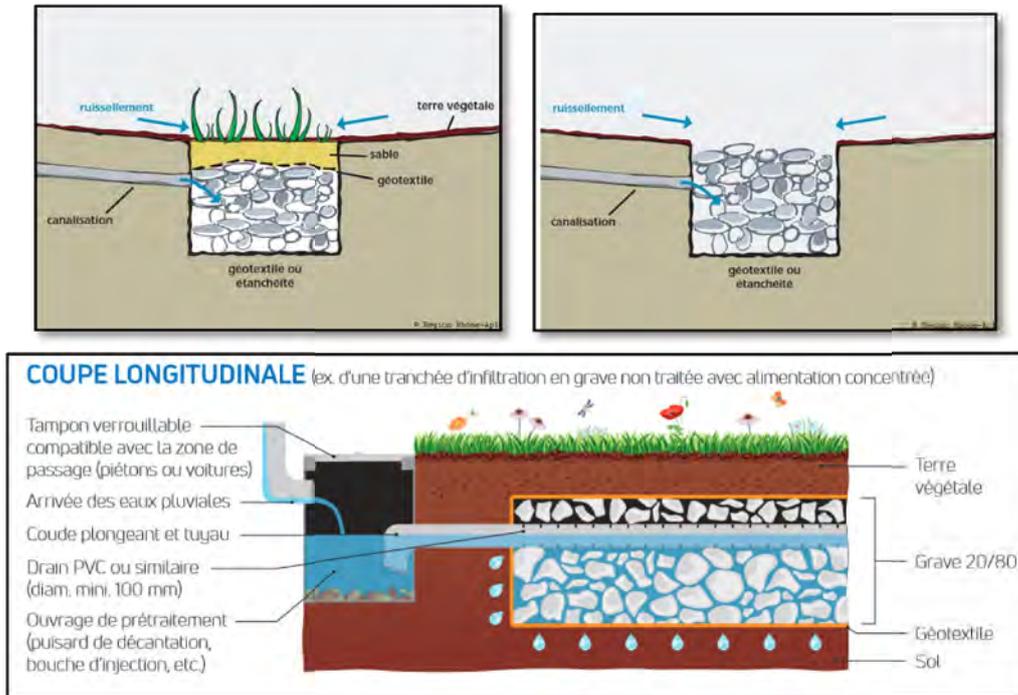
Exemple de tranchée d'infiltration en pied de bâtiment
